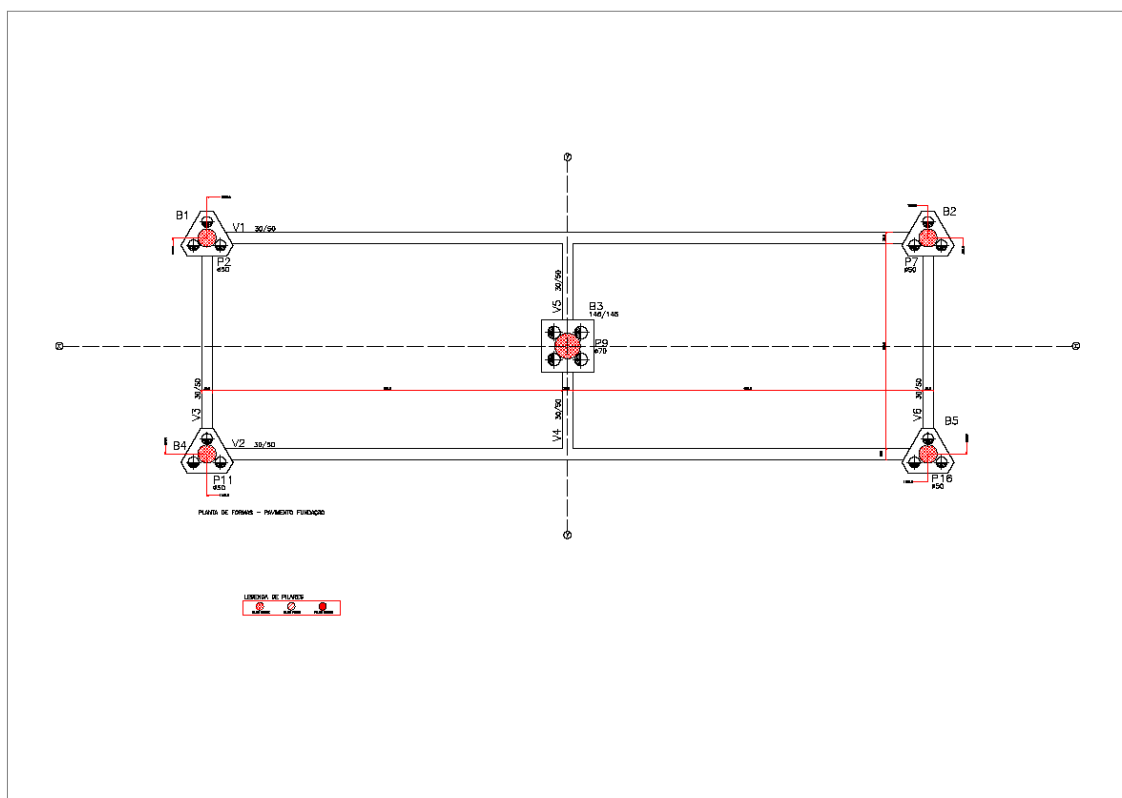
Planta de formas do pavimento baldrame. Fonte: AUTOR (2017).
